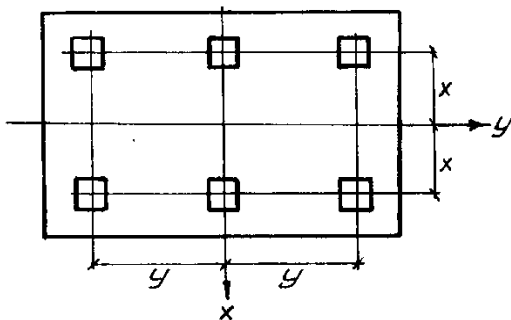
Определение расстояний от главных осей ростверка до оси каждой сваи
